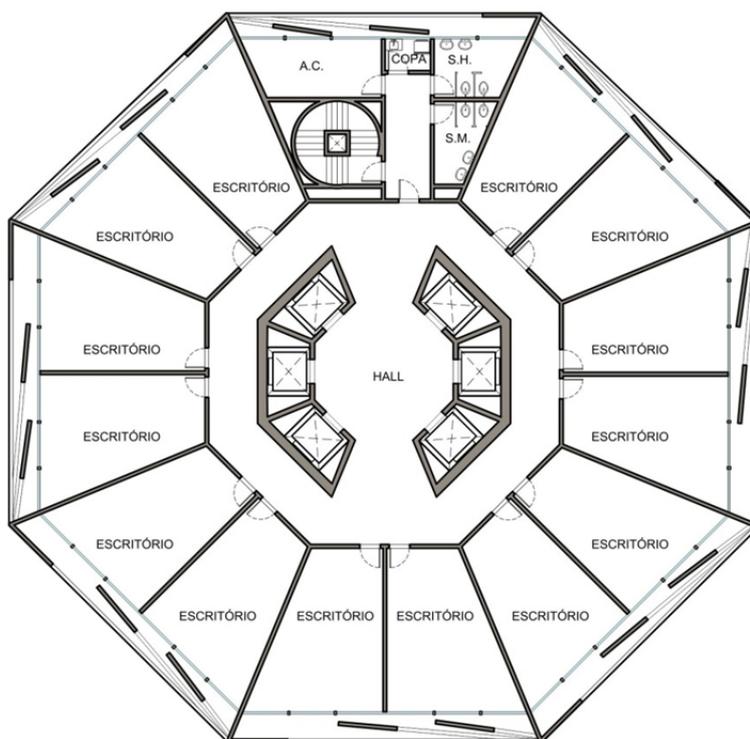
Planta do pavimento tipo da sede do Banco Safra
